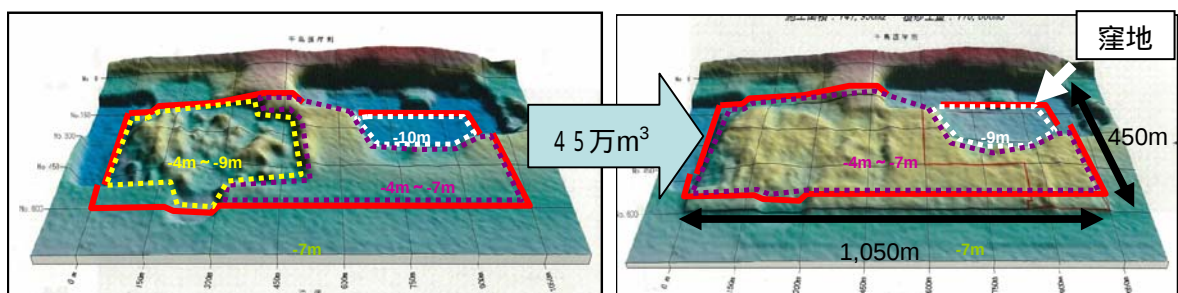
覆砂工事施工区域(H17 施工区域、H18 施工区域)
